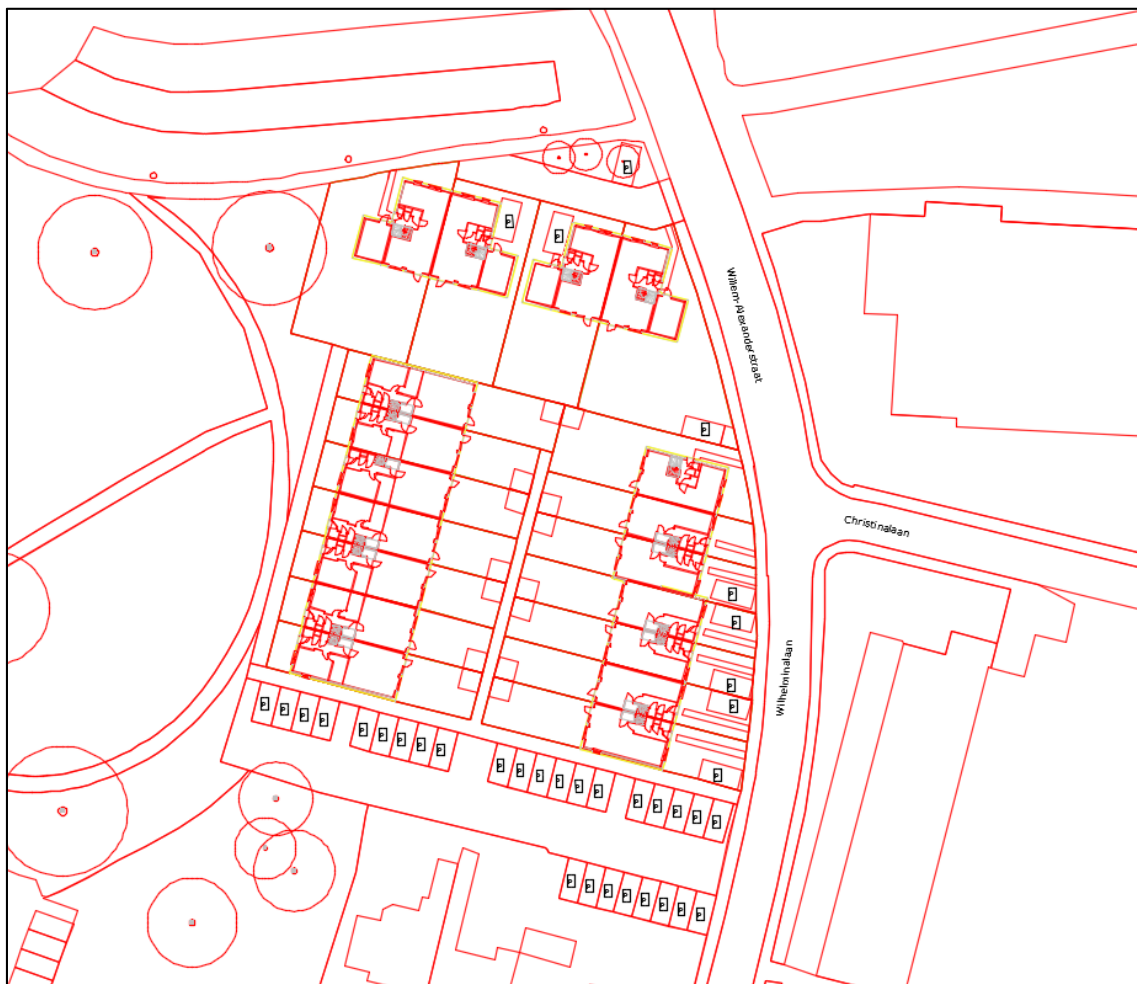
Locatie plangebied (ondergrond top10nl, noordgericht)
